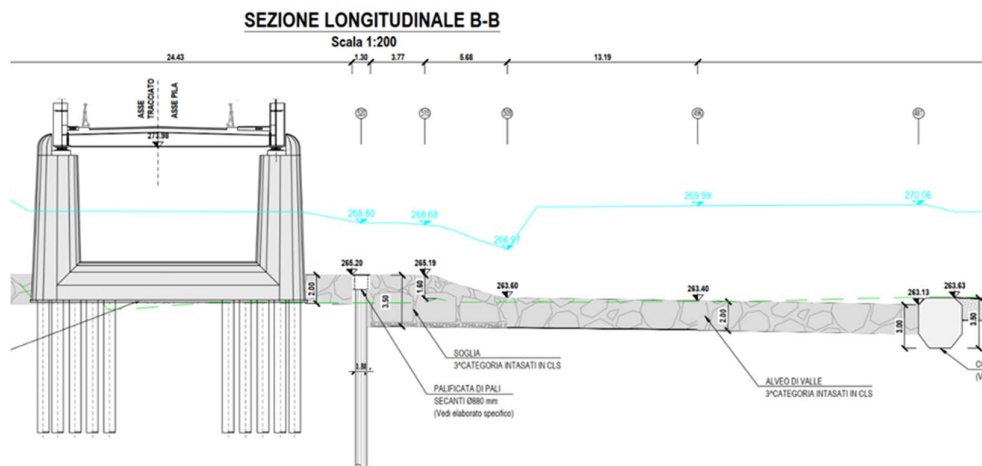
Stralcio profilo longitudinale dell'intervento.
